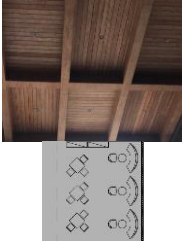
Denah zona B dan penempatan titik lampu zona B
